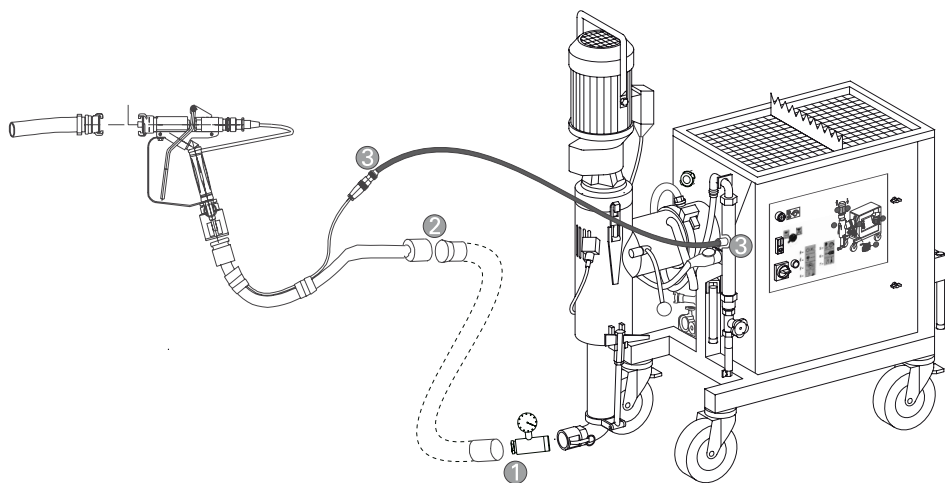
Anschlüsse bei Verwendung einer Klebepistole
